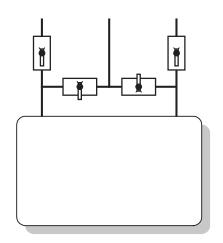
(Layout collegamenti idraulici; Layout hydraulic connections)
